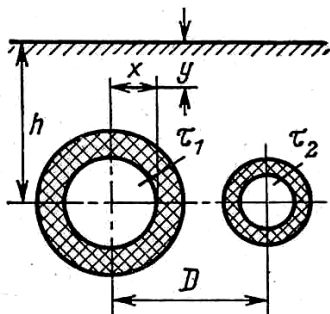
Схема двохтрубно-го безканального теплопроводу
